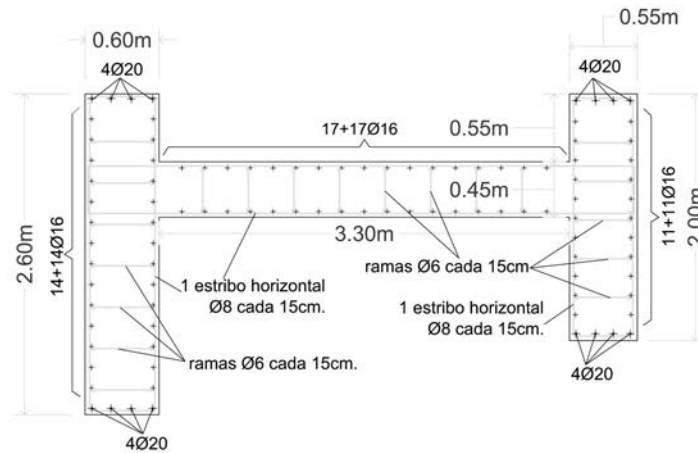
Dimensiones y armado del soporte 7 en plantas inferiores
